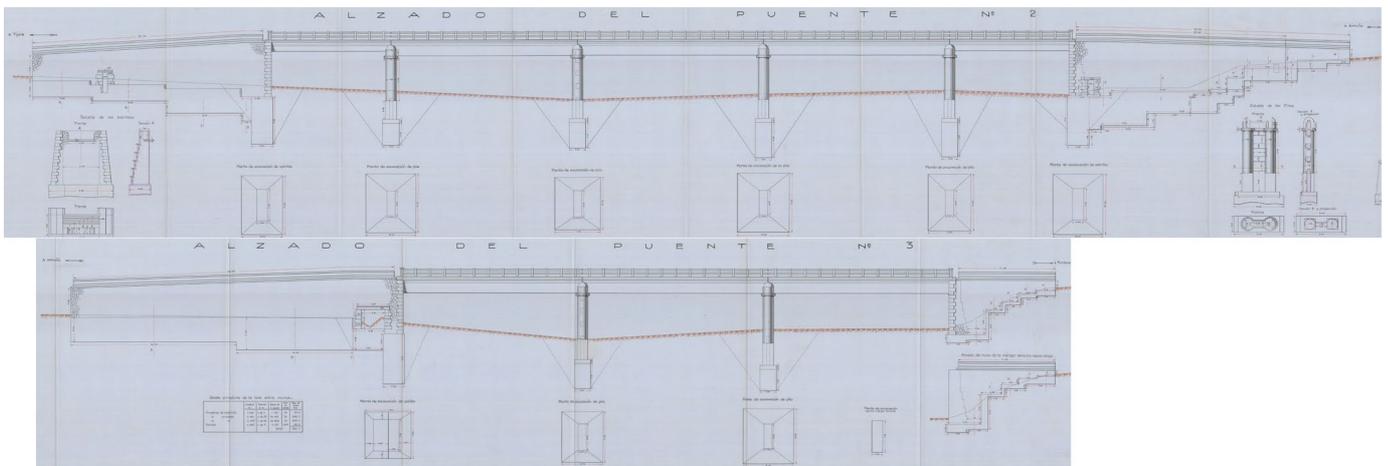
Puente número 2 sobre el río Almanzora [10]. Archivo General de la Administración.
